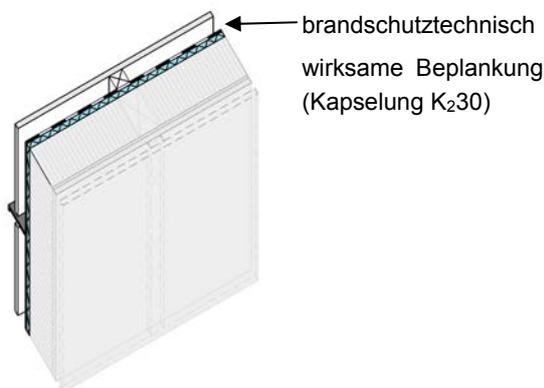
Abschluss der Kernwand zur Fassadenkonstruktion
